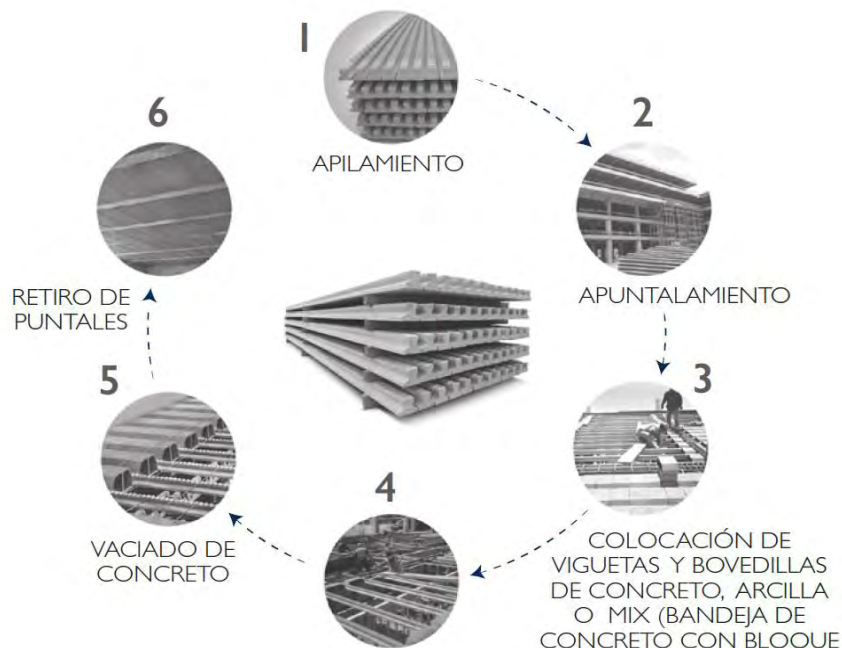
Procesos del proceso constructivo de losas con viguetas prefabricadas.
